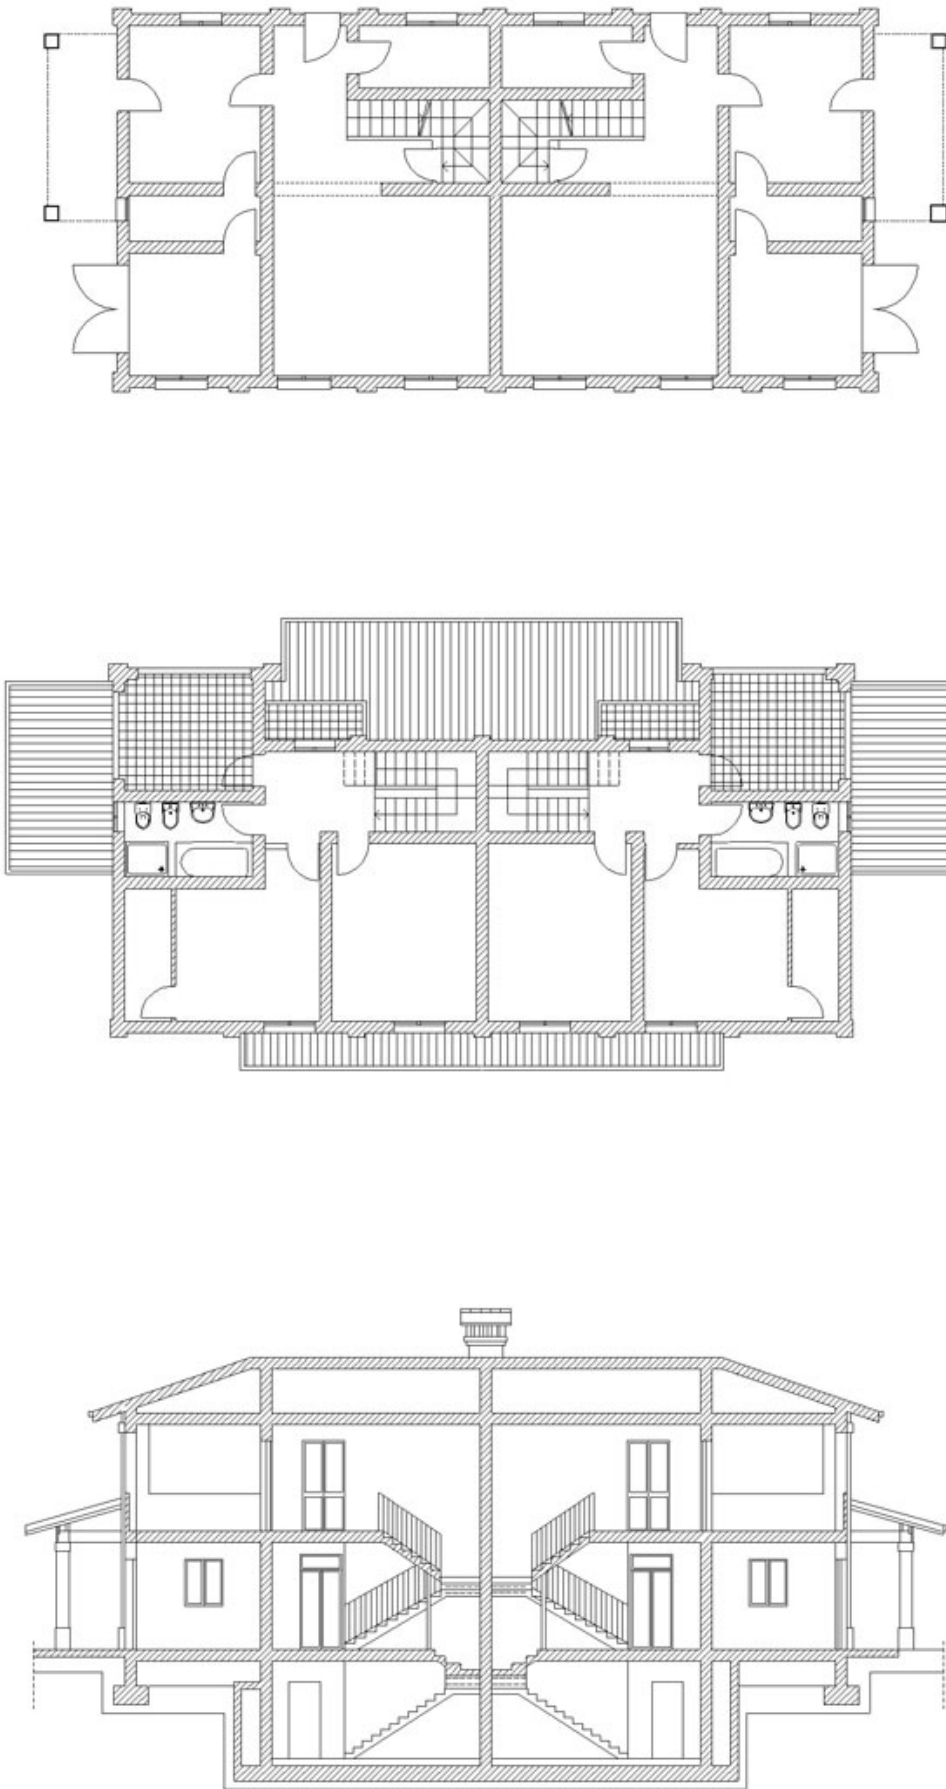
Edificio residenziale tipo: pianta del piano terra, del piano primo e sezione longitudinale.
